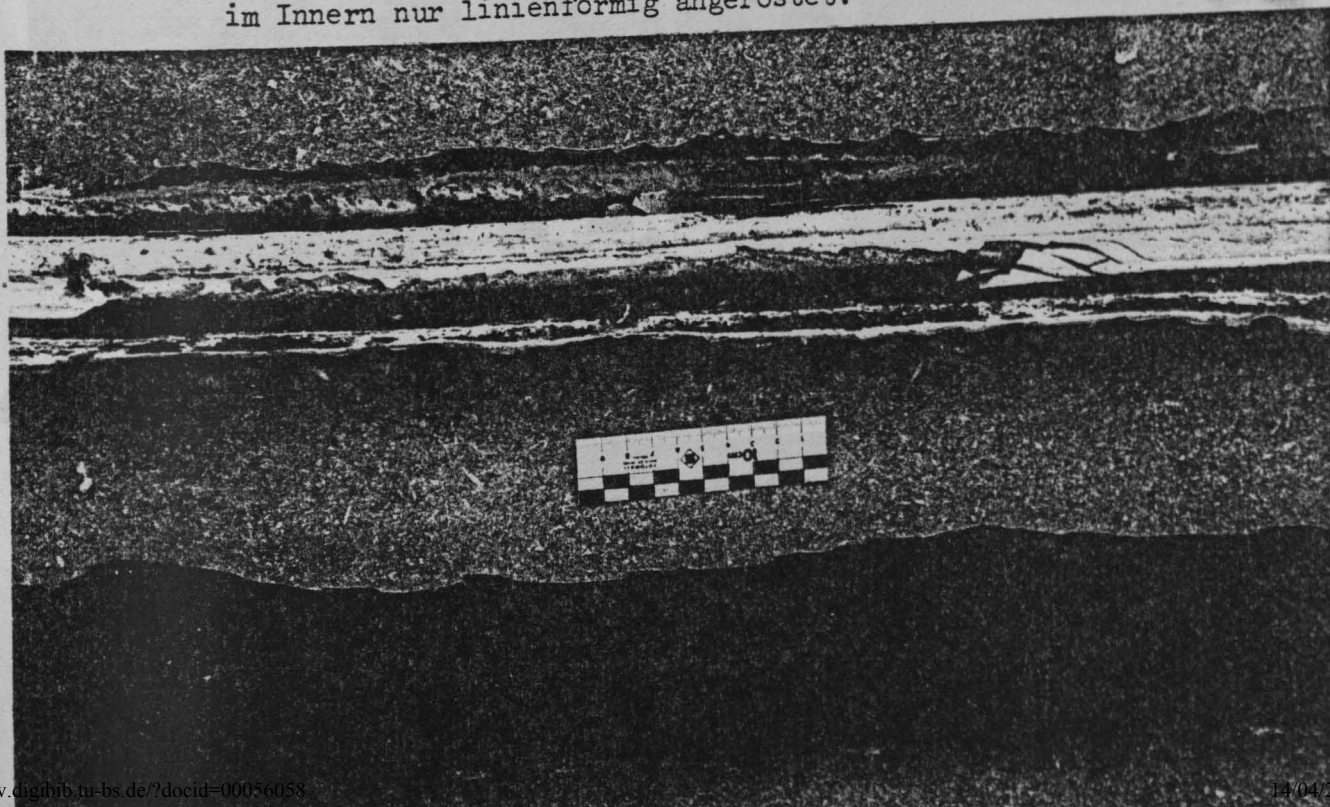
oben Betonstahl Nr. 1a; unten Betonstahl Nr. 1b nach Anlage 7;
